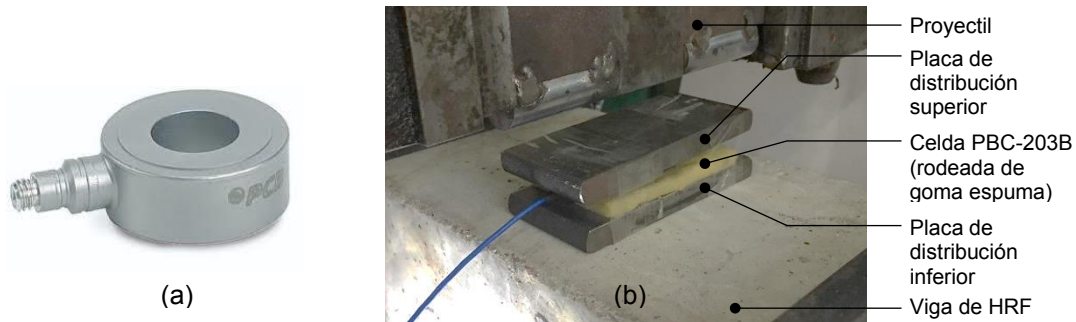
(a) Celda de carga PCB-203B. (b) Montaje de celda de carga con placas de distribución.
